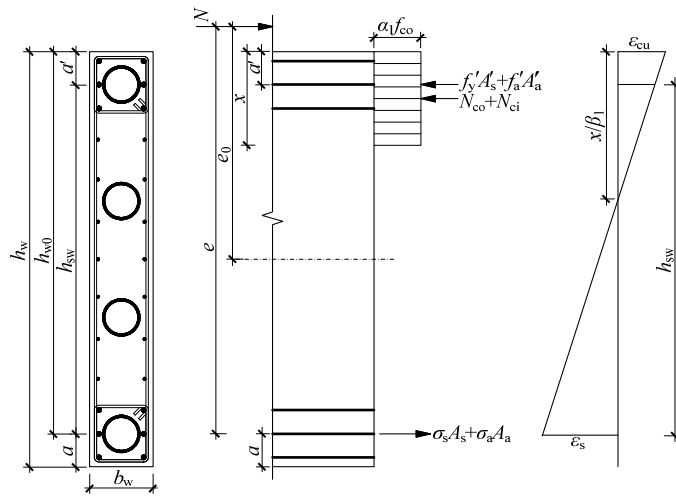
矩形截面偏心受压钢管混凝土剪力墙正截面受压承载力计算参数示意
